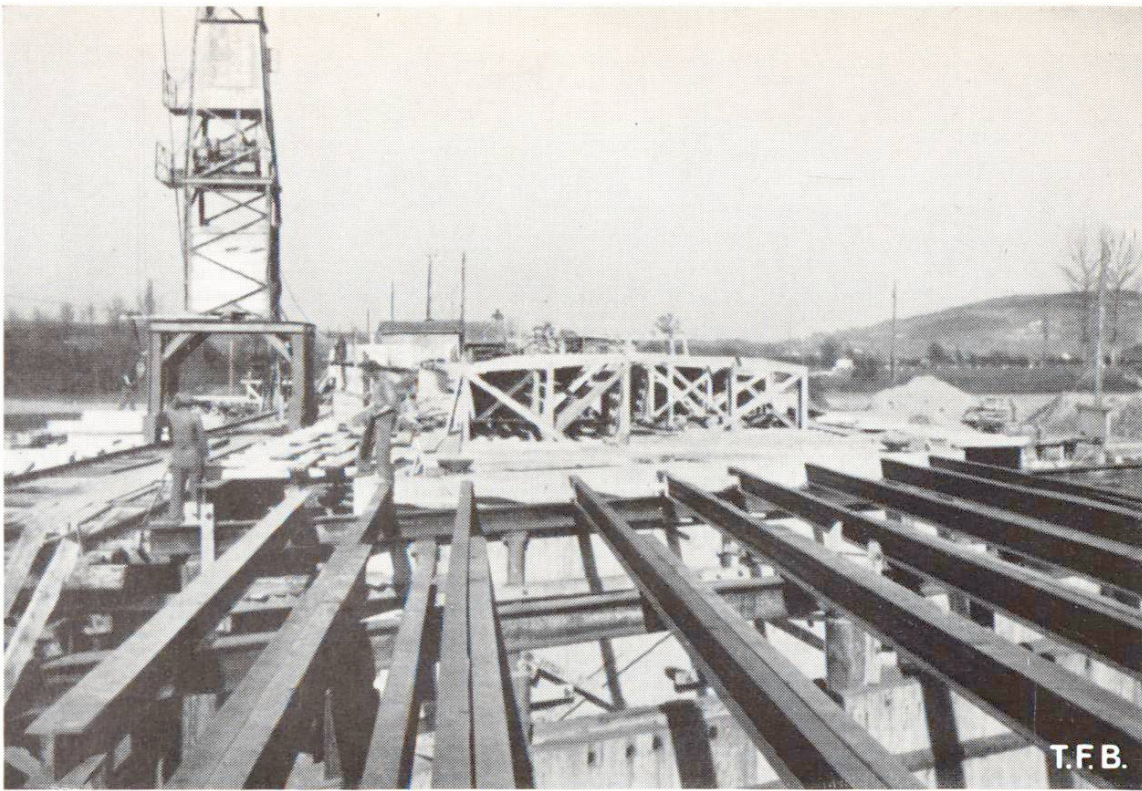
Fers profilés reposant sur les cadres en bois. En arrière, coffrages en place
